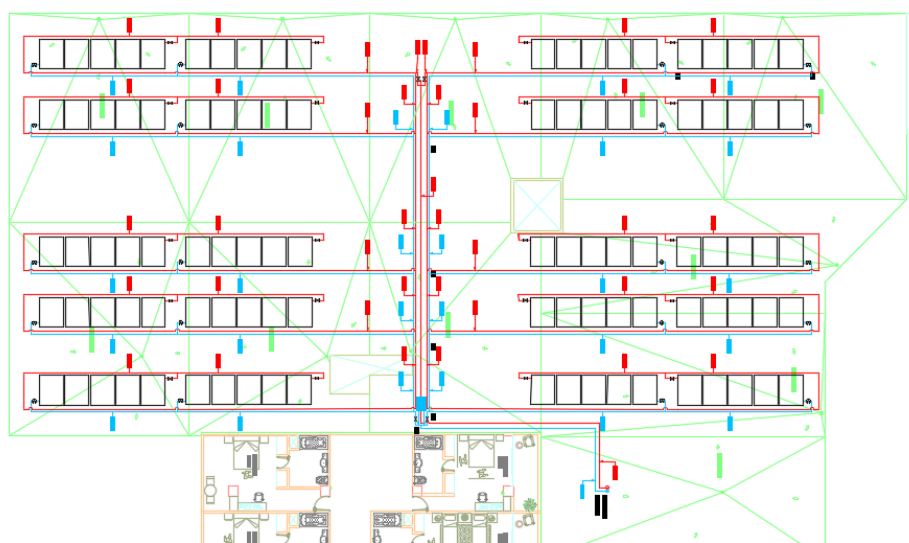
Campo de captadores solares en polideportivo. Planos del proyecto
